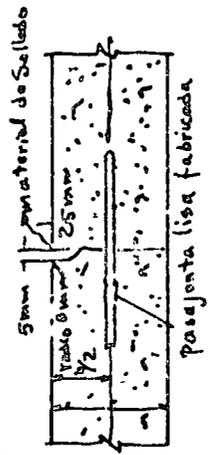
(c) DETALLES RECOMENDADOS DE DISEÑO DE JUNTAS ARTICULADAS LONGITUDINALES PARA CARRETERAS.
